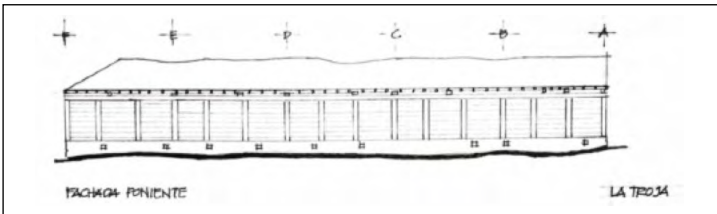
Fachada poniente. Dibujo: René Navarrete (2019).
